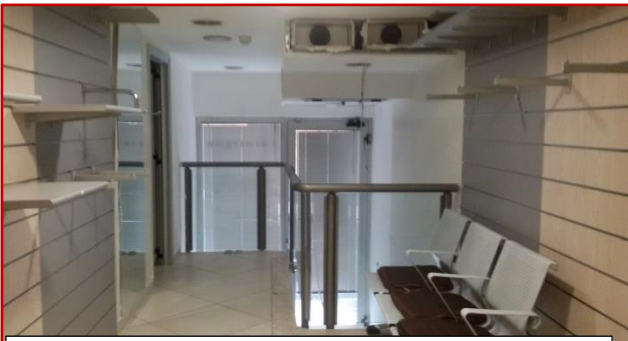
piano rialzato- affaccio su accesso lato strada
